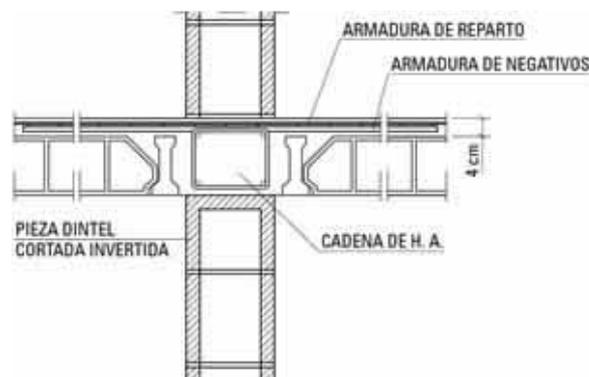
Apoyo de forjado en muro de arriostramiento.
